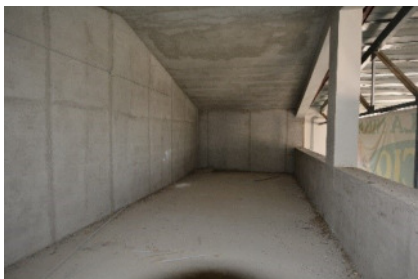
Capannone – solaio di copertura area uffici (vista verso parete Sud)
